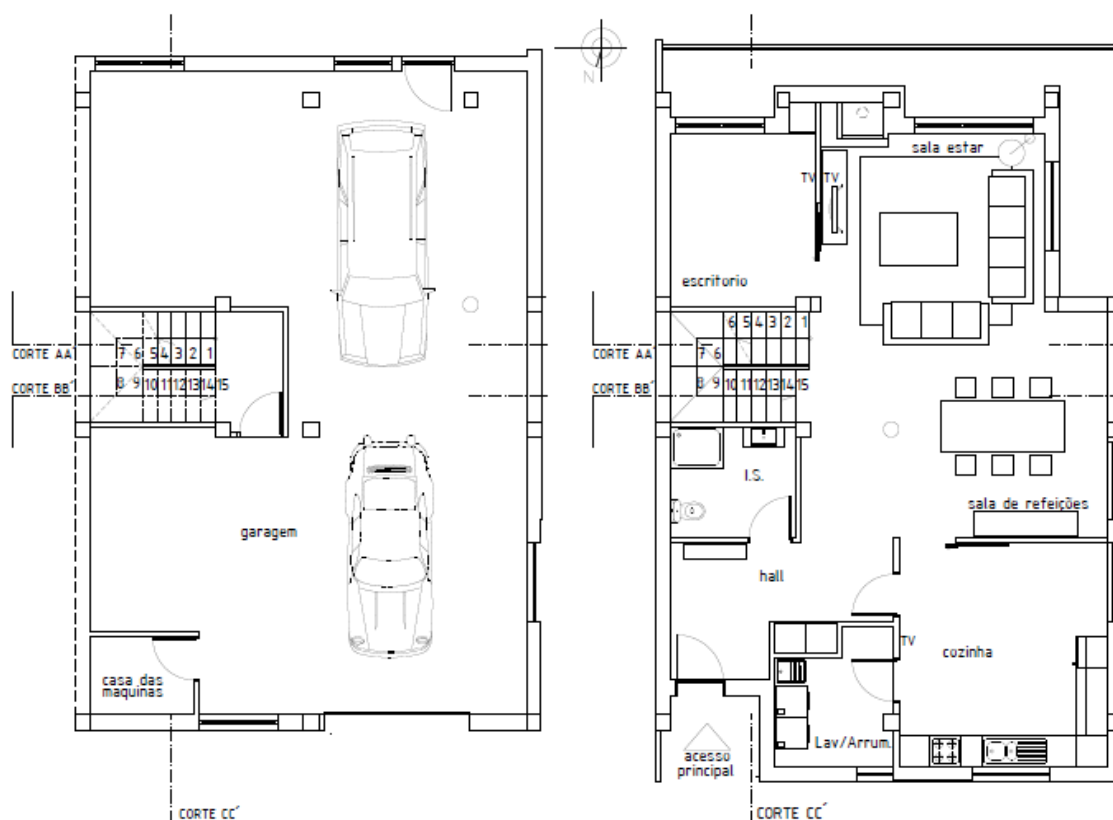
Planta baixa da cave à esquerda e planta baixa do rés-de-chão à direita.
